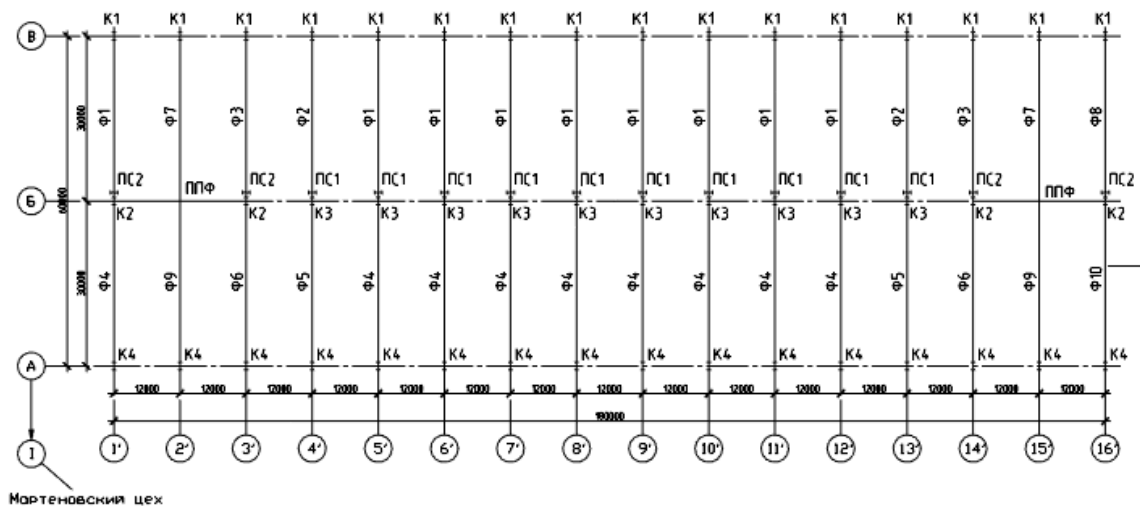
План колонн, подкрановых стоек, стропильных и подкраново-подстропильных ферм здания ОНЛЗ
